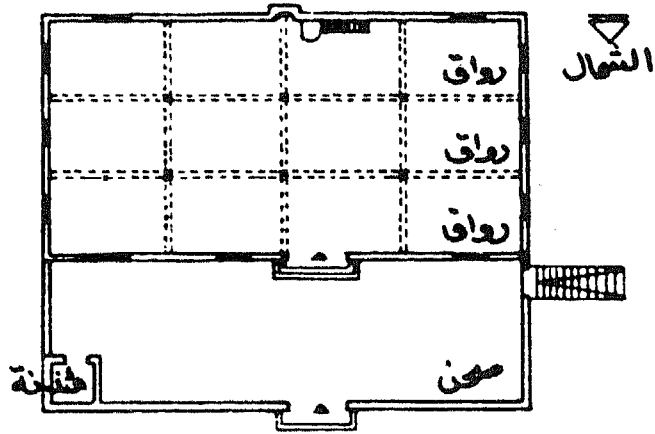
مسقط افقى لمسجد الغمامة بالمدينة المنورة .
